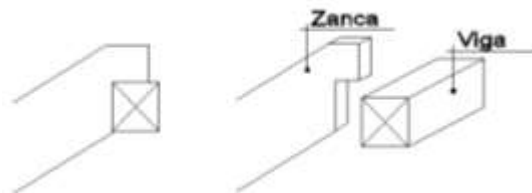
Detalle constructivo – Unión zanca – viga de entrepiso
